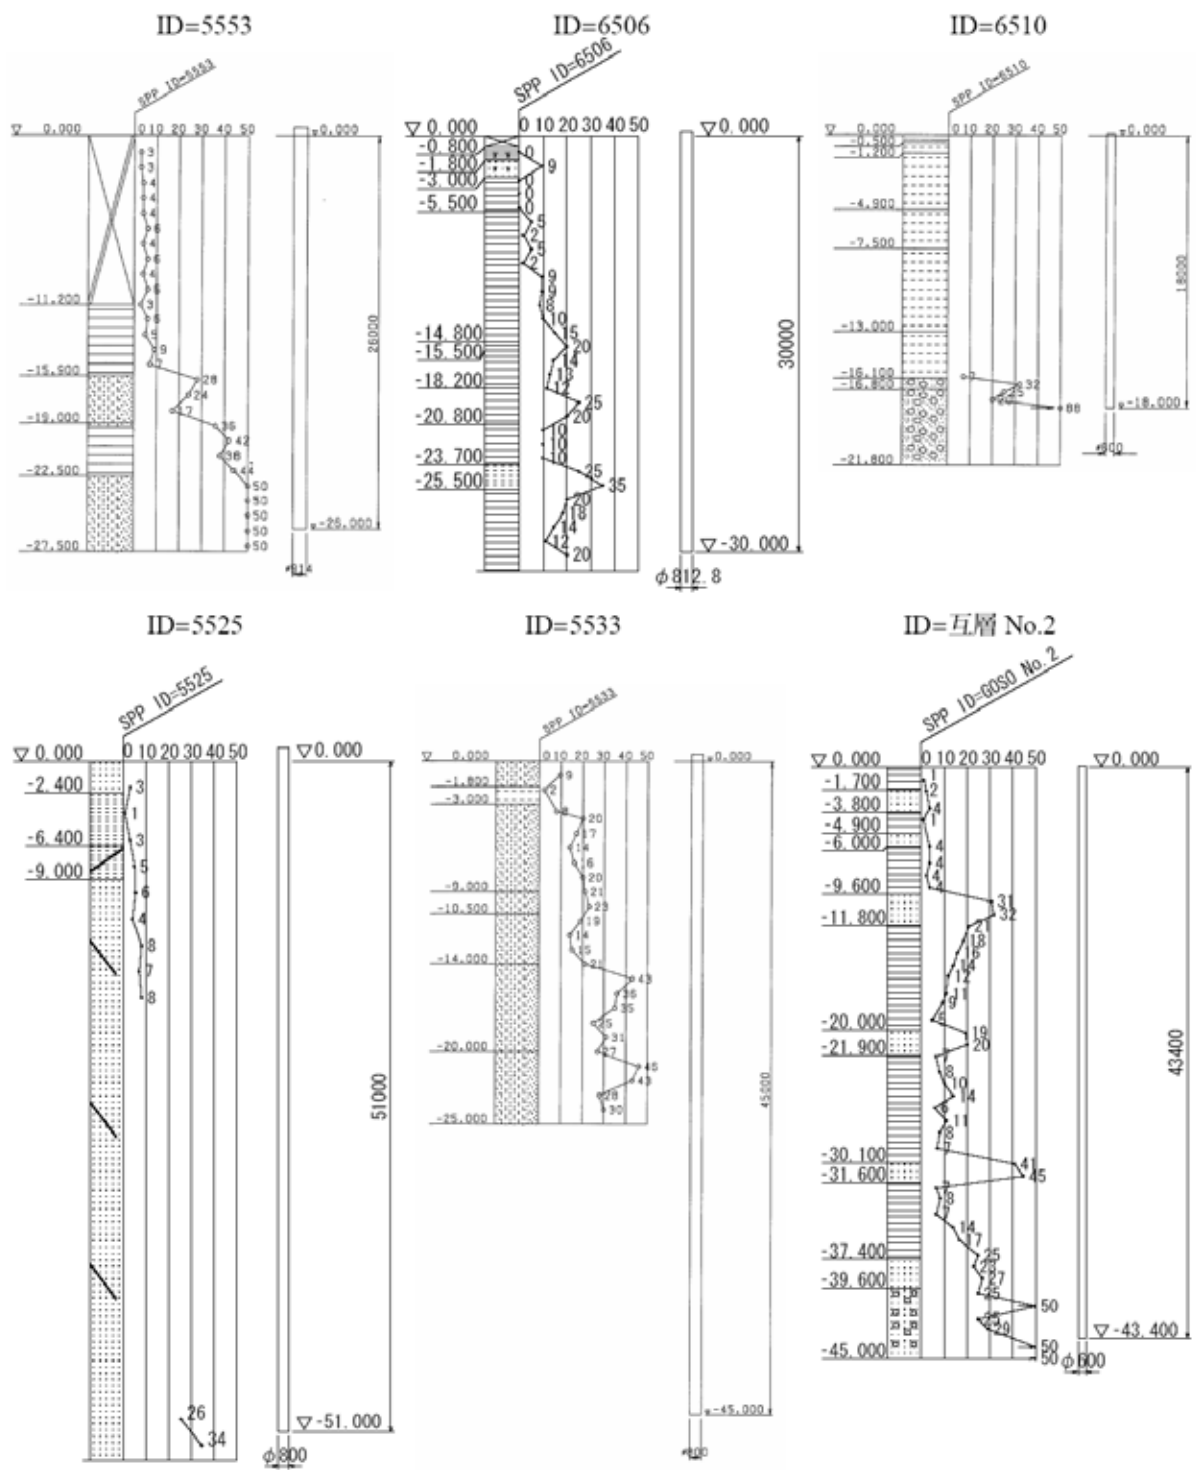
ボーリング柱状図 (単杭その2 単位: mm)
